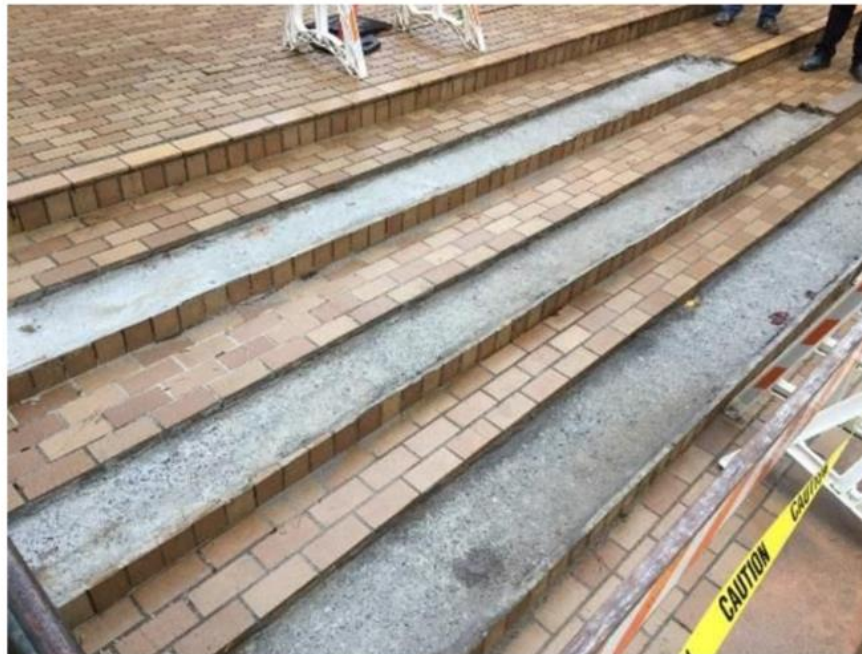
Fundición de escaleras con la nueva mezcla de concreto
